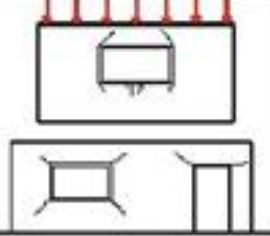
Principais tipos de fissuras ou trincas encontradas em uma edificação
